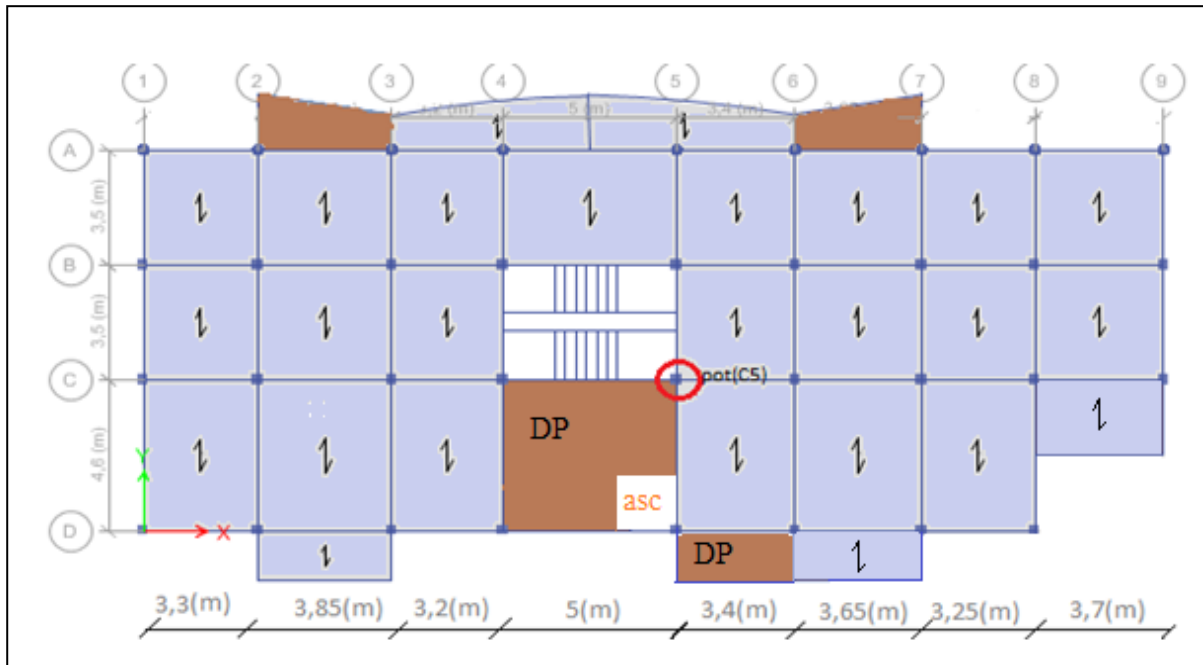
Schéma de la disposition des poutrelles pour les étages courants.
